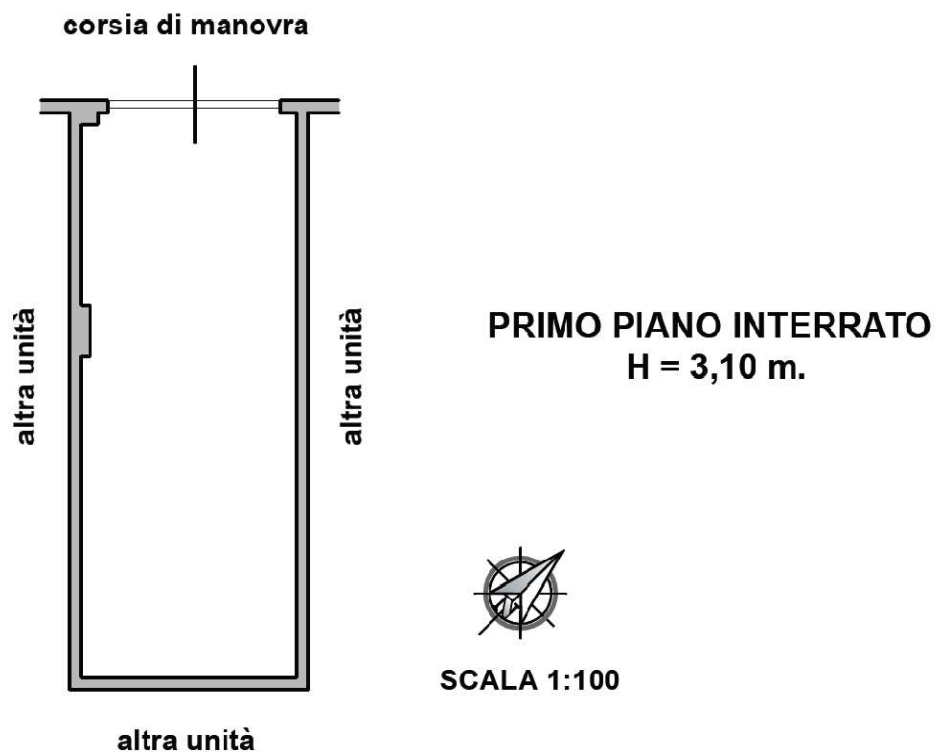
LOTTO 29 – Planimetria box auto foglio 76 – part. 620 – sub. 229
